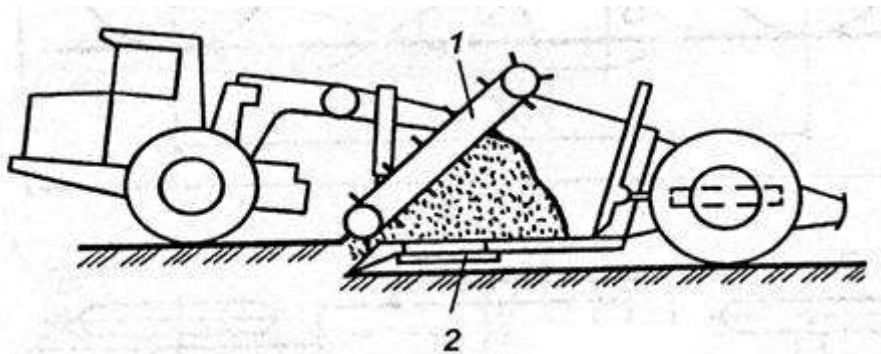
Схема скрепера с элеваторной загрузкой: 1 — элеватор с приводом; 2 — подвижное днище.
